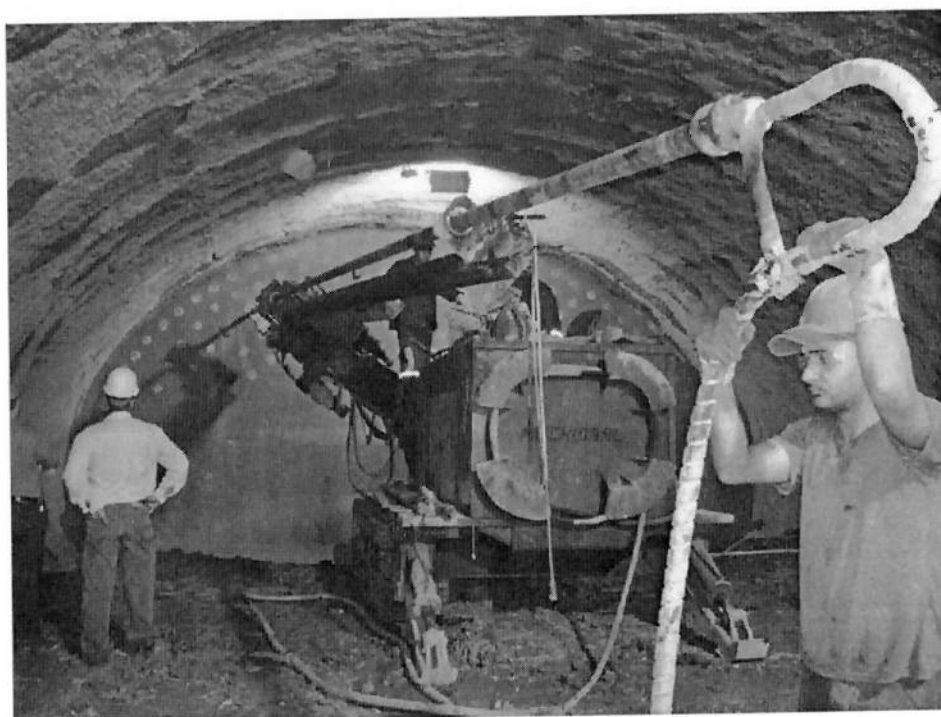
Foto da injeção de concreto para estruturação antes da escavação
